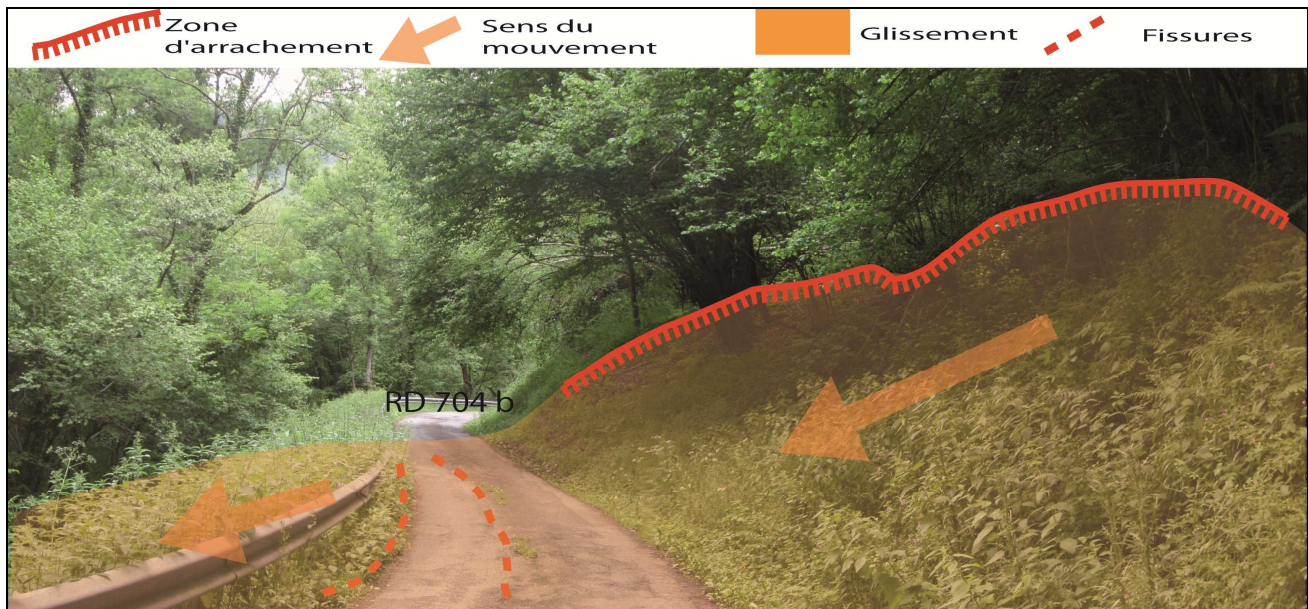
Désordres sur la chaussée dans le pied de versant à Marbre (source: Agerin)
